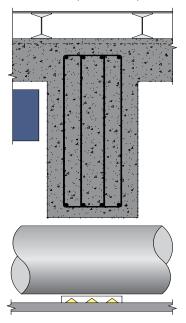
Схема организации монолитного железобетонного балочного перекрытия. В данном решении можно уменьшить габарит перекрытия путем применения каналов прямоугольного сечения
